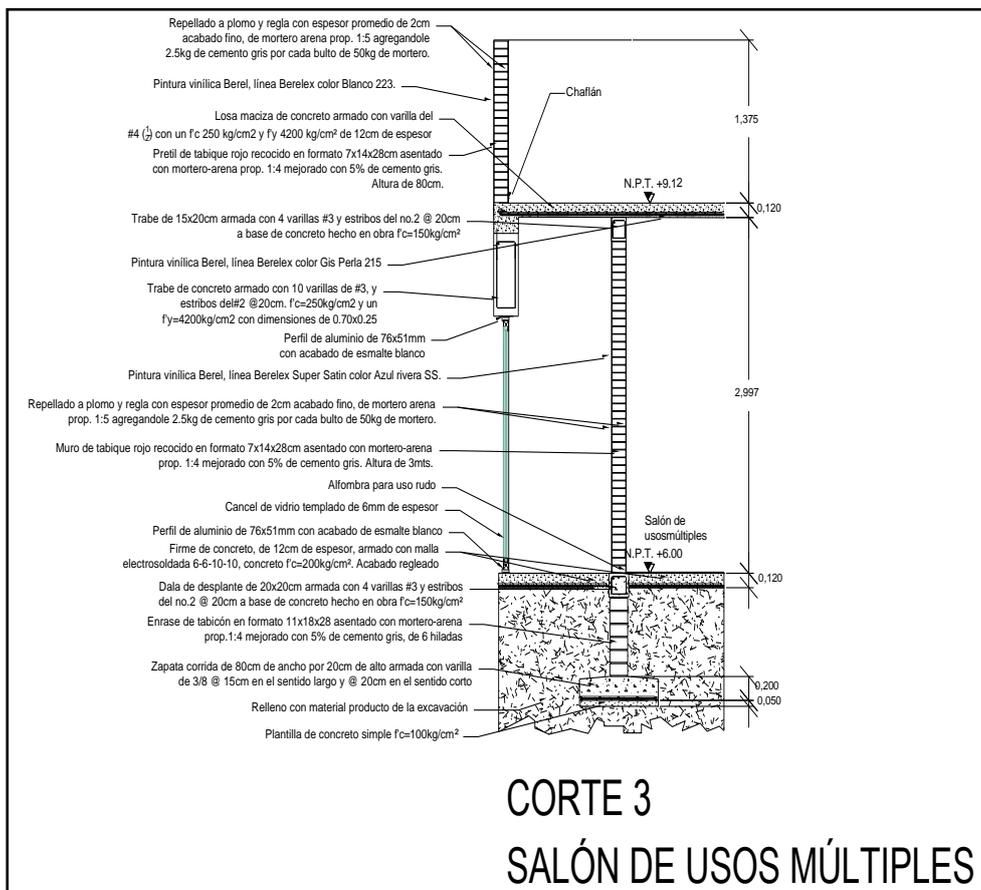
Corte por fachada del salón de usos múltiples. Fuente: AutoCad, elaborada por D.A.M.
